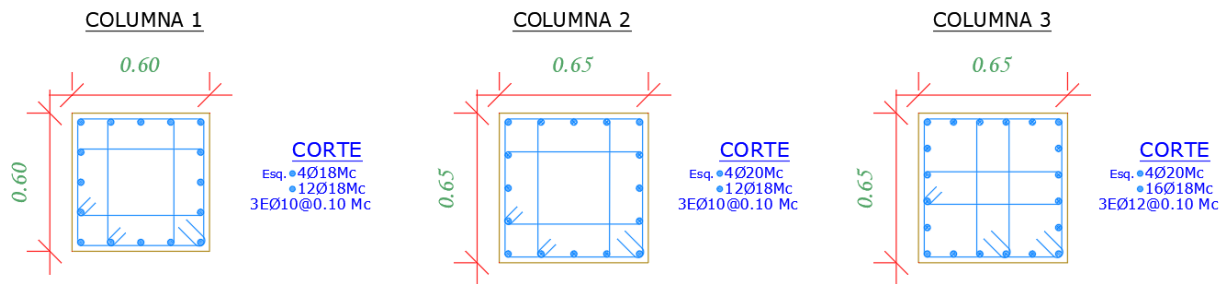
Sección transversal de la columna utilizada en un edificio de 6 pisos.
